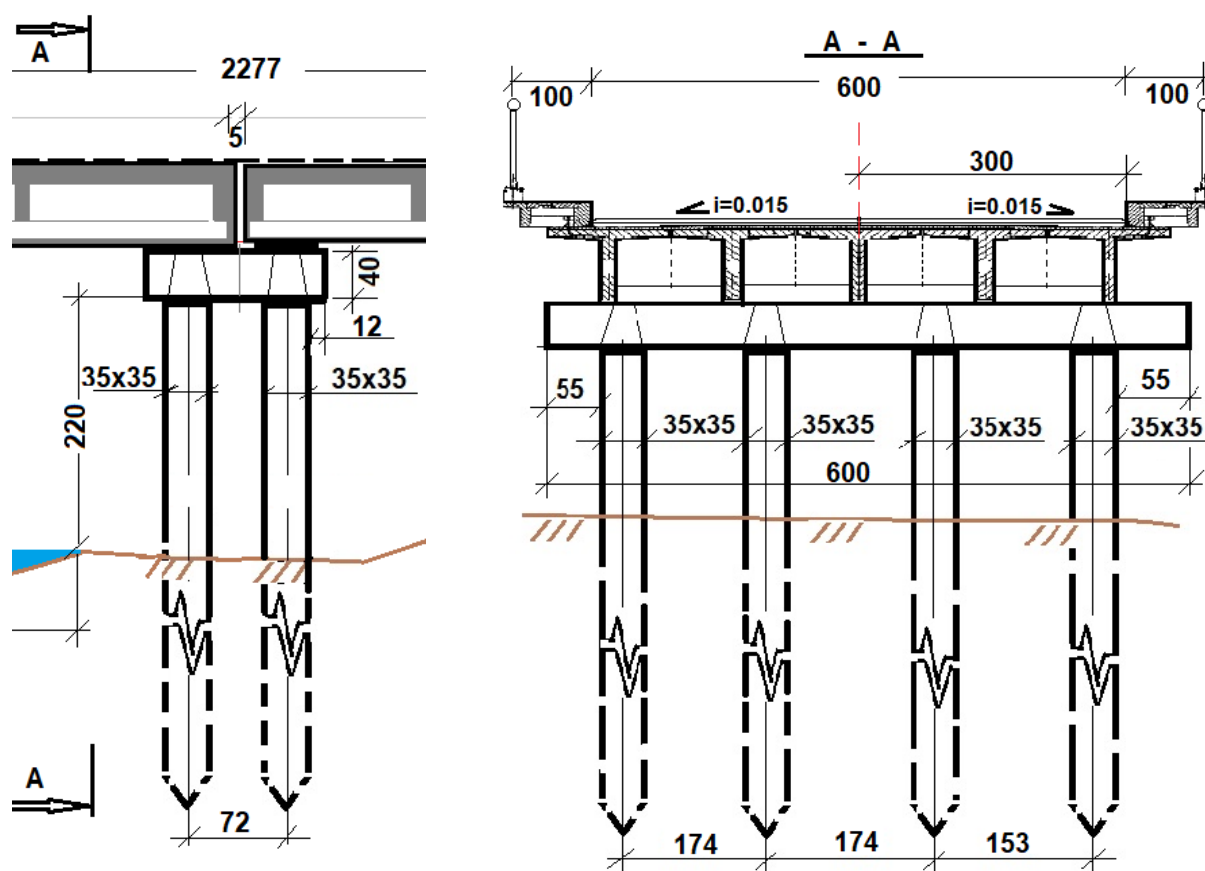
Geometria și dimensionarea pilei intermediare P1.
